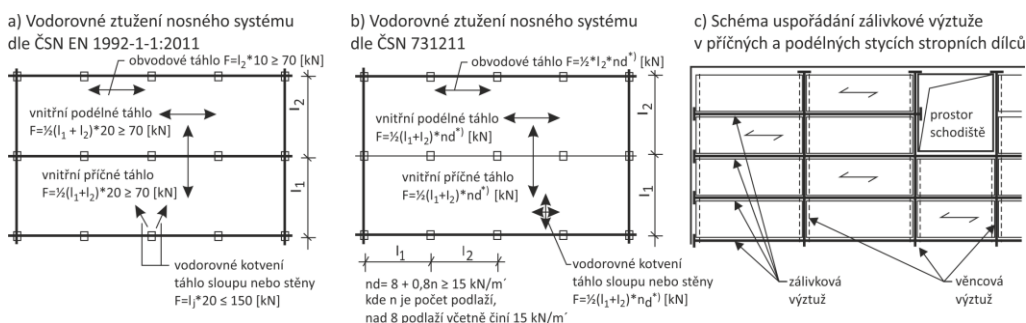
Zálivková a věncová výztuž prefabrikovaných stropních konstrukcí
